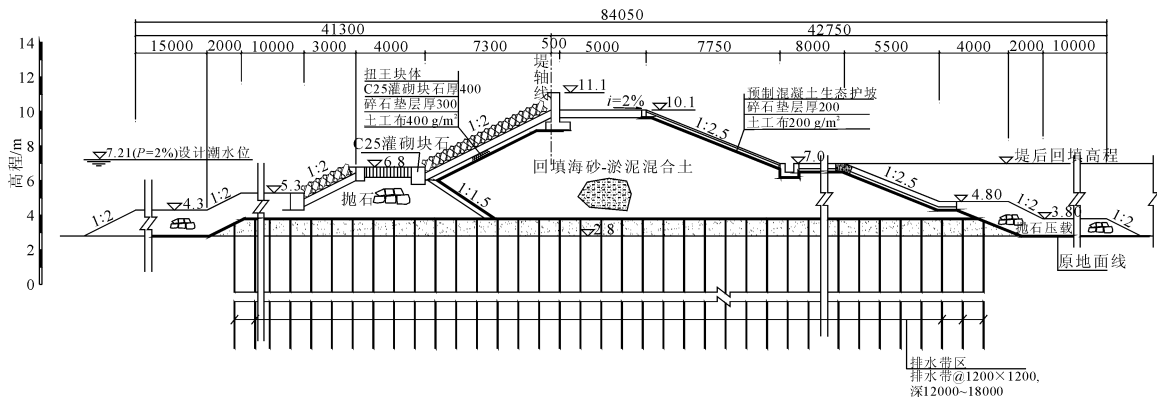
海堤设计标准断面图(平面尺寸单位:mm)
